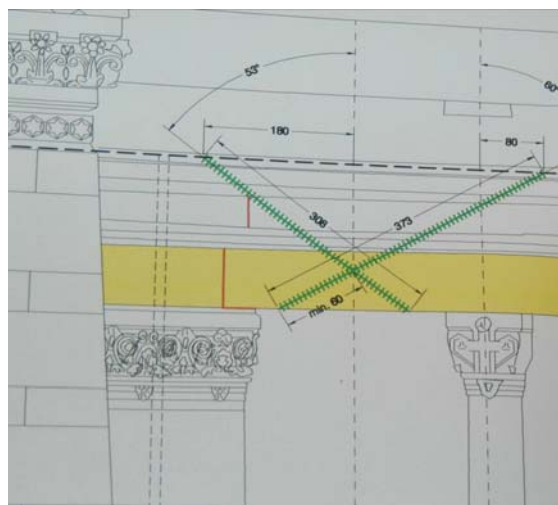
posizionamento delle cuciture - Fig. 12 – prospetto nord sezione trasversale della trabeazione
